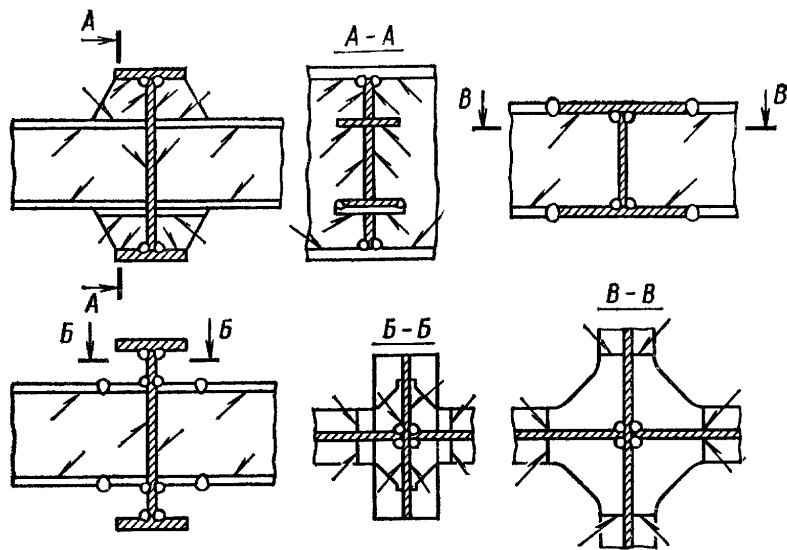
Сварные соединения балок двутаврового профиля между собой
